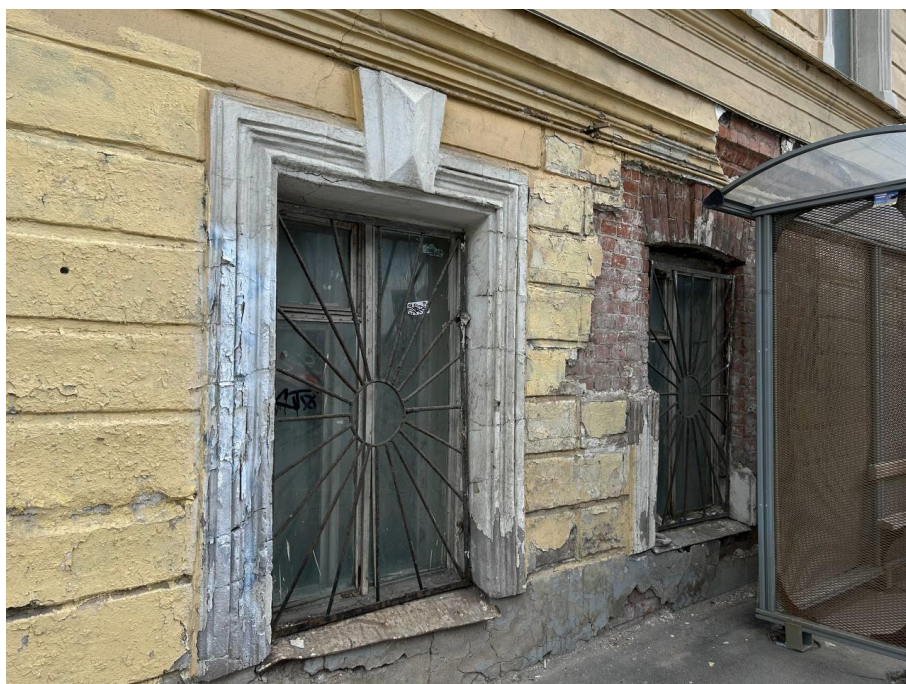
Окна 1-го этажа на западном фасаде, вид с Лиговского проспекта.
